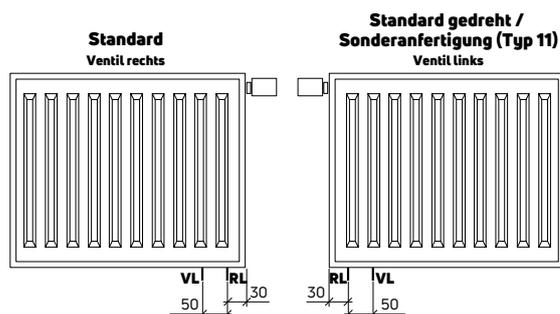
Anschlusslage Ventil rechts und Ventil links
